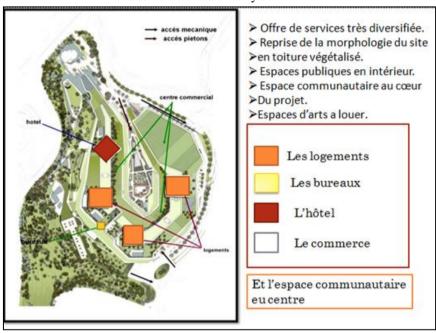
Plan de masse Zorlu Center. Source : www.archdaily.com
